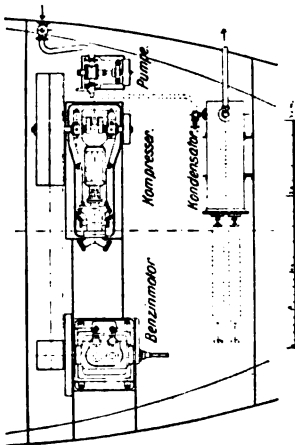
Grundriß des Maschinenraums 1 : 300.
